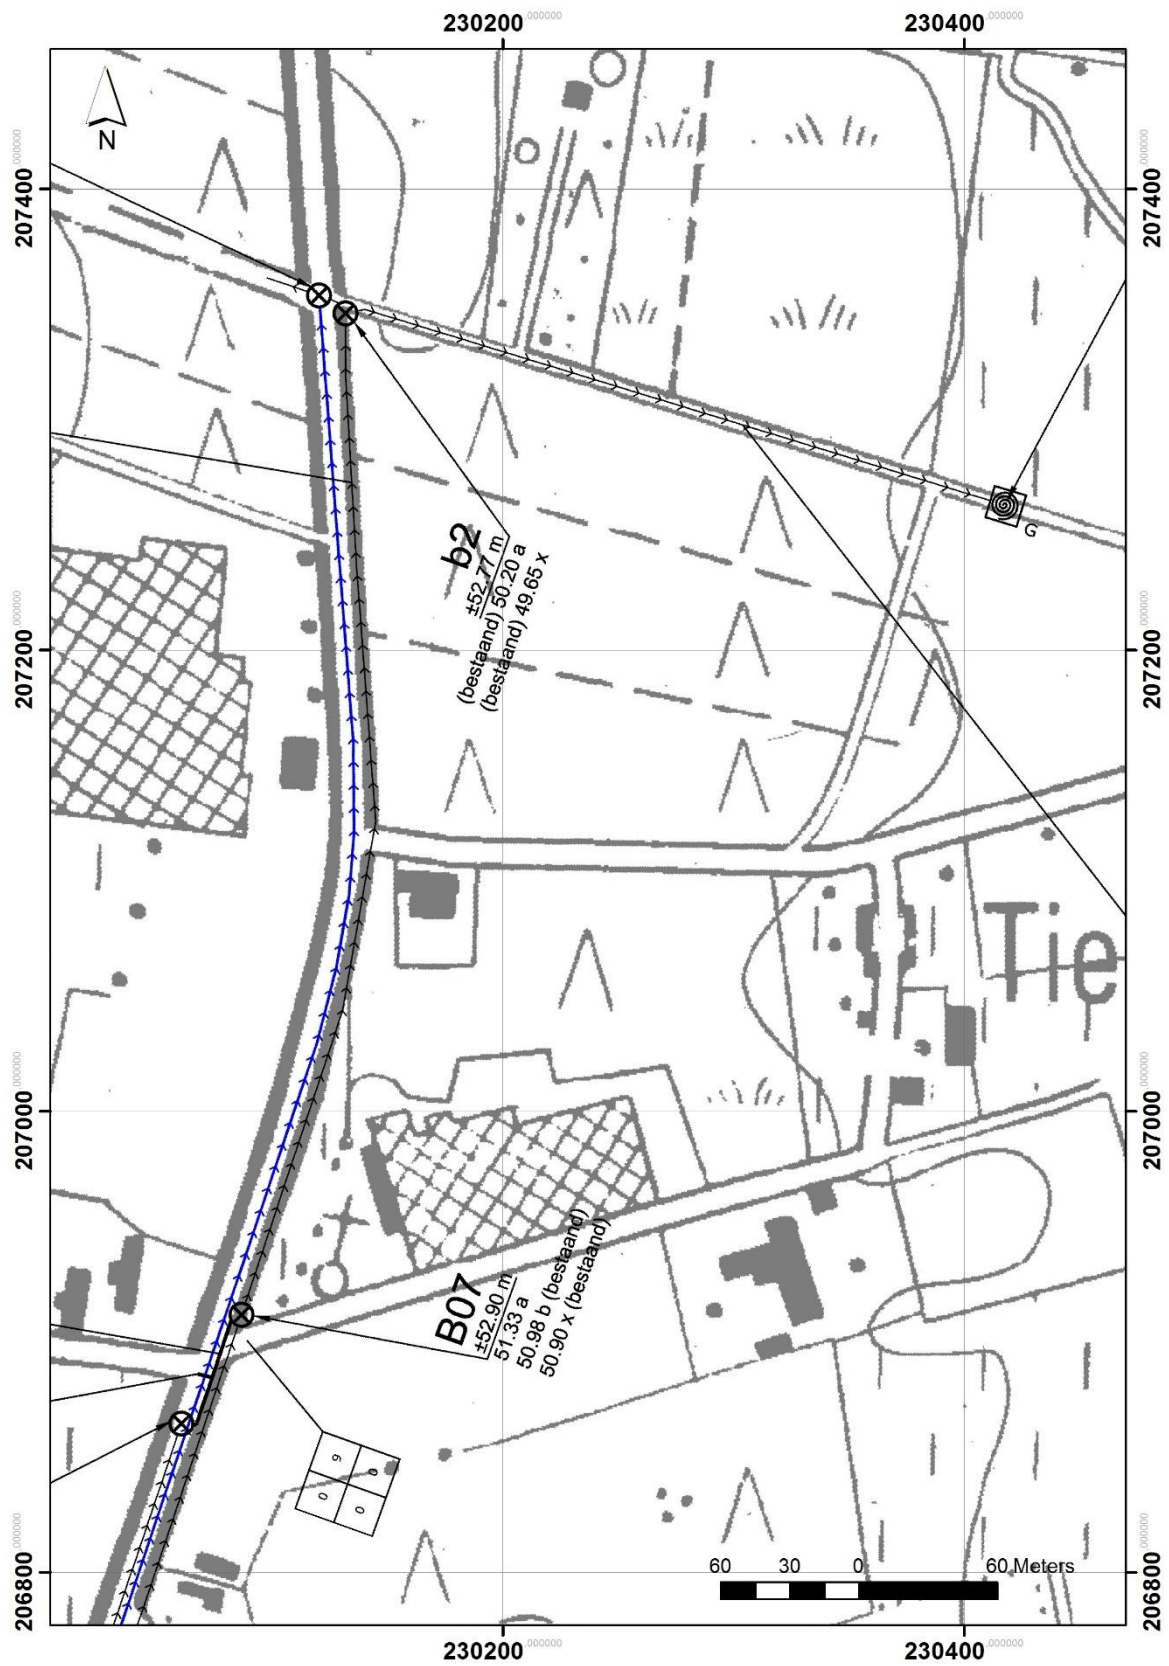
ontwerpplan met schematische aanduiding van de opdeling (volledig plan wordt ook als digitale bijlage toegevoegd)
